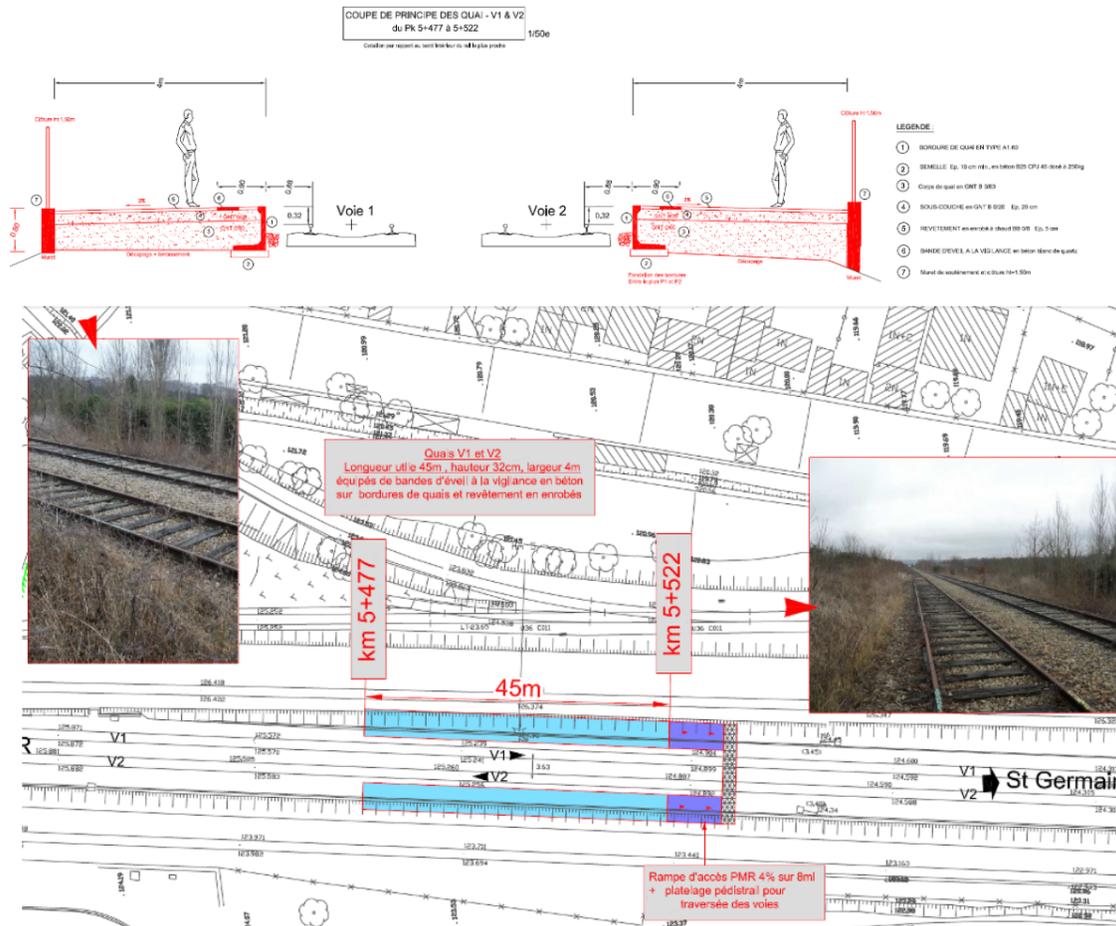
Plan et coupe d'aménagement de la station Saint-Cyr ZAC (Source : SNCF Réseau – avril 2015)
